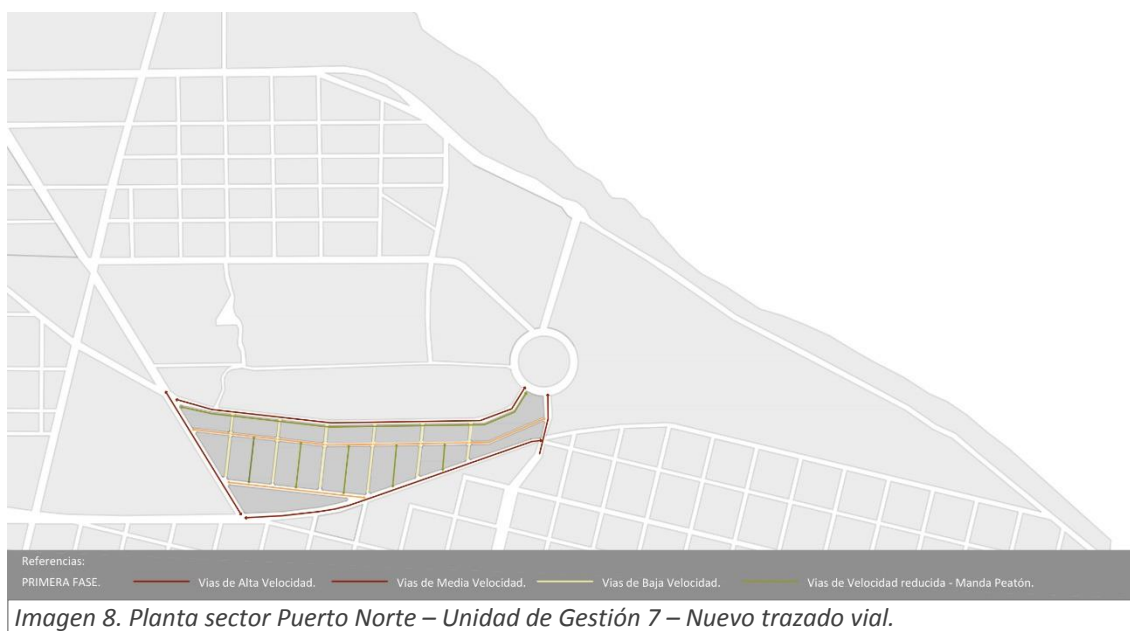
Planta sector Puerto Norte – Unidad de Gestión 7 – Nuevo trazado vial.
